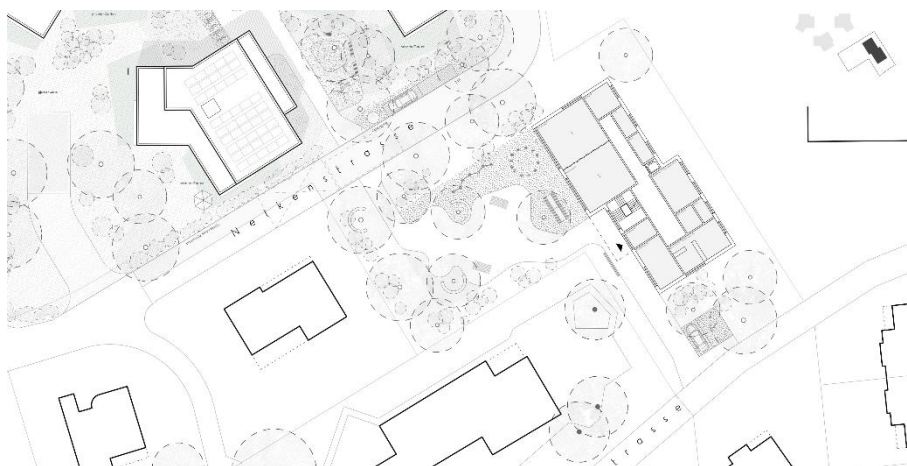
Kindergarten Grundriss Erdgeschoss
